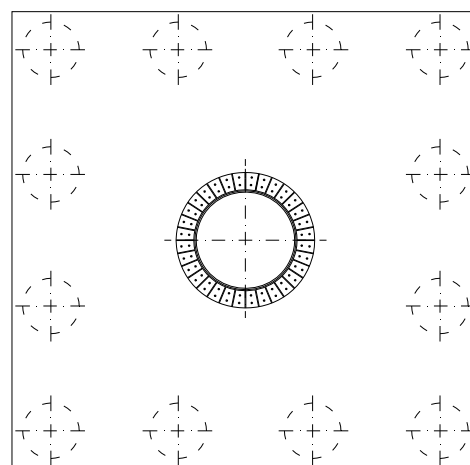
Двенадцатисвайный фундамент из буронабивных свай. Вид сверху.
